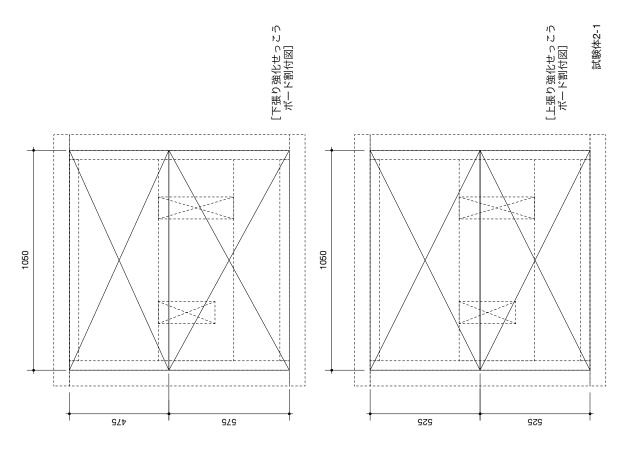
試験体 2-1 壁-床取合い部 試験体図
